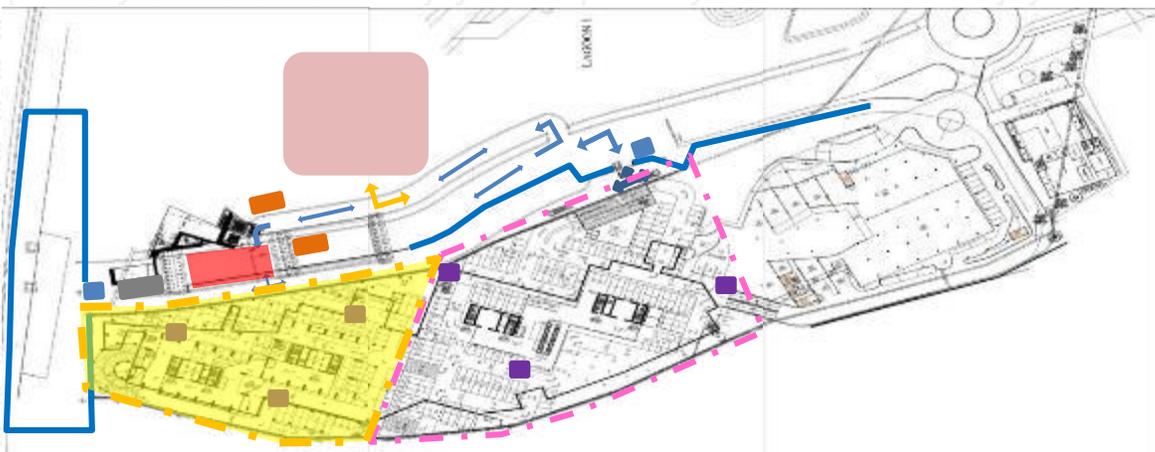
Siteplan Pembangunan Tahap I Proyek Grand Kamala Lagoon
